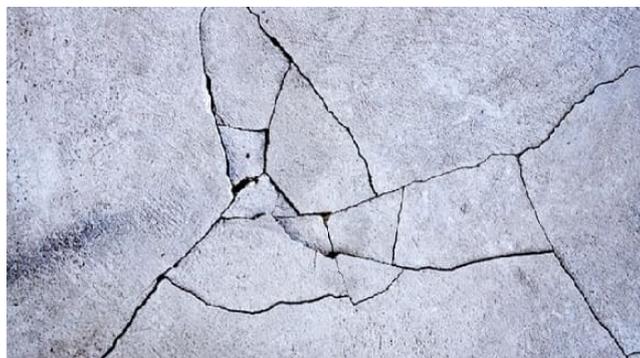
Exemplo de rachaduras e fissuras
